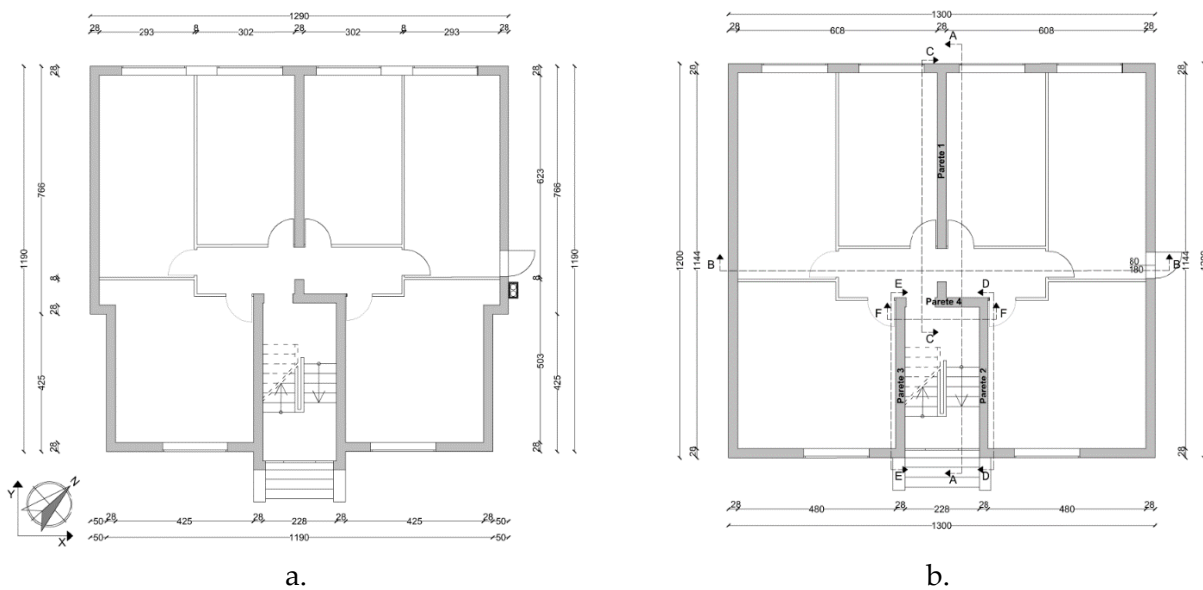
Pianta piano terra: a) reale; b) semplificata.
